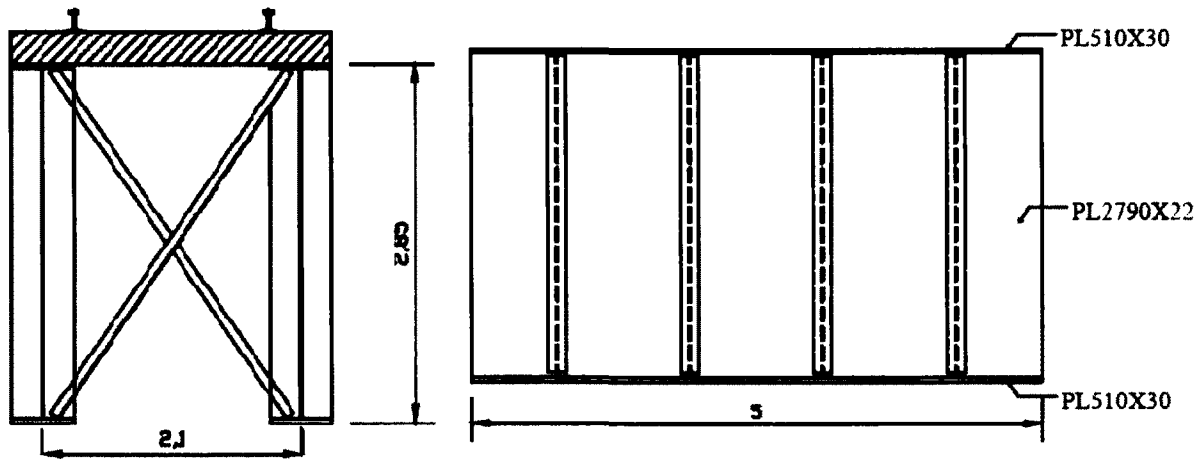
Pont bi-poutres - Section transversale et élévation - Section F-3
